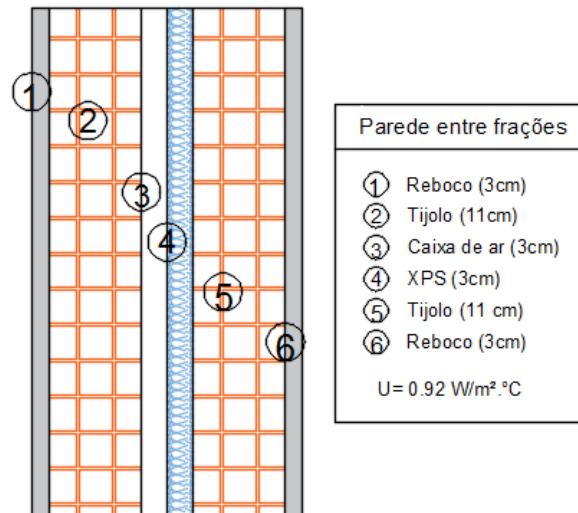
Pormenor e características da parede entre frações e zonas não úteis
